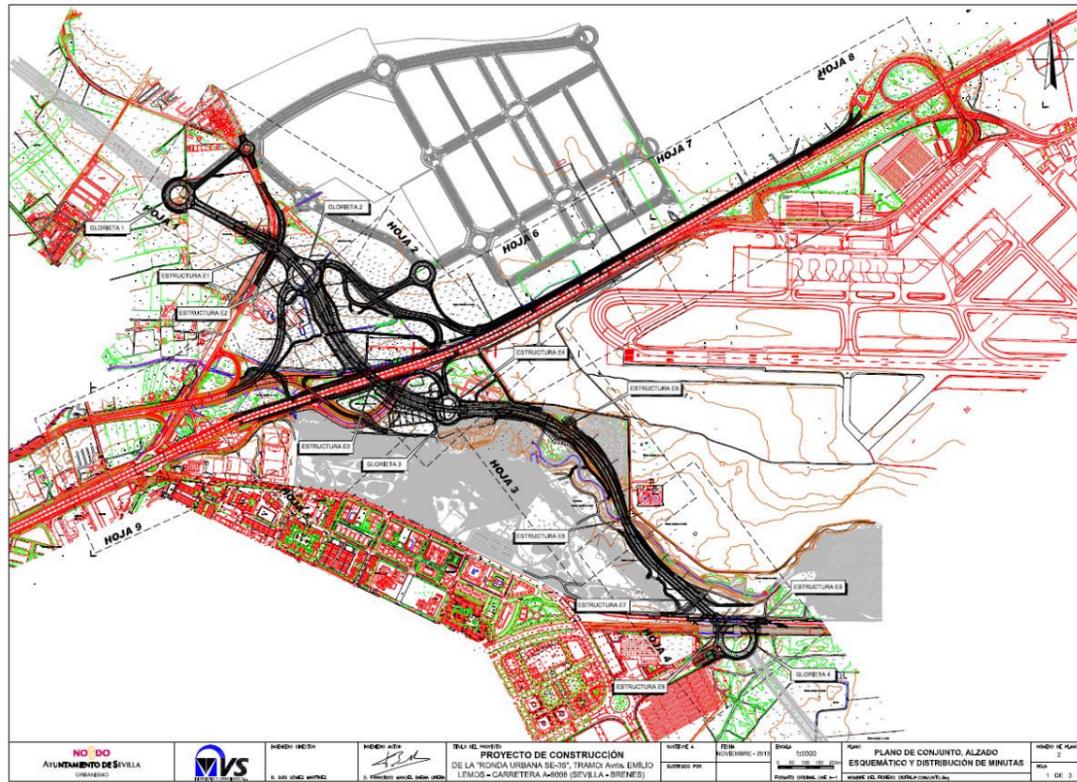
Plano 3. "Plano de Conjunto. Alzado esquemático y distribución de Minutas". Proyecto de Construcción "Ronda Urbana SE-35, Tramo: Avda. Emilio Lemos – Carretera A-8008 (Sevilla-Brenes)"
